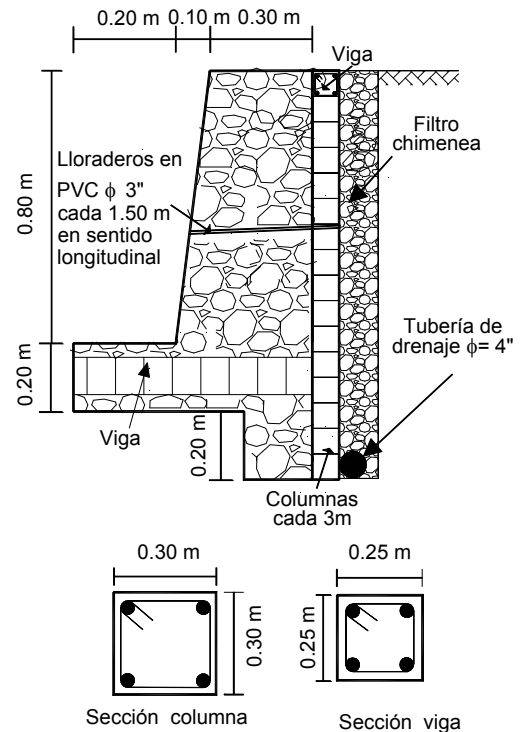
Esquema de un muro de concreto ciclópeo con columnetas de refuerzo.
